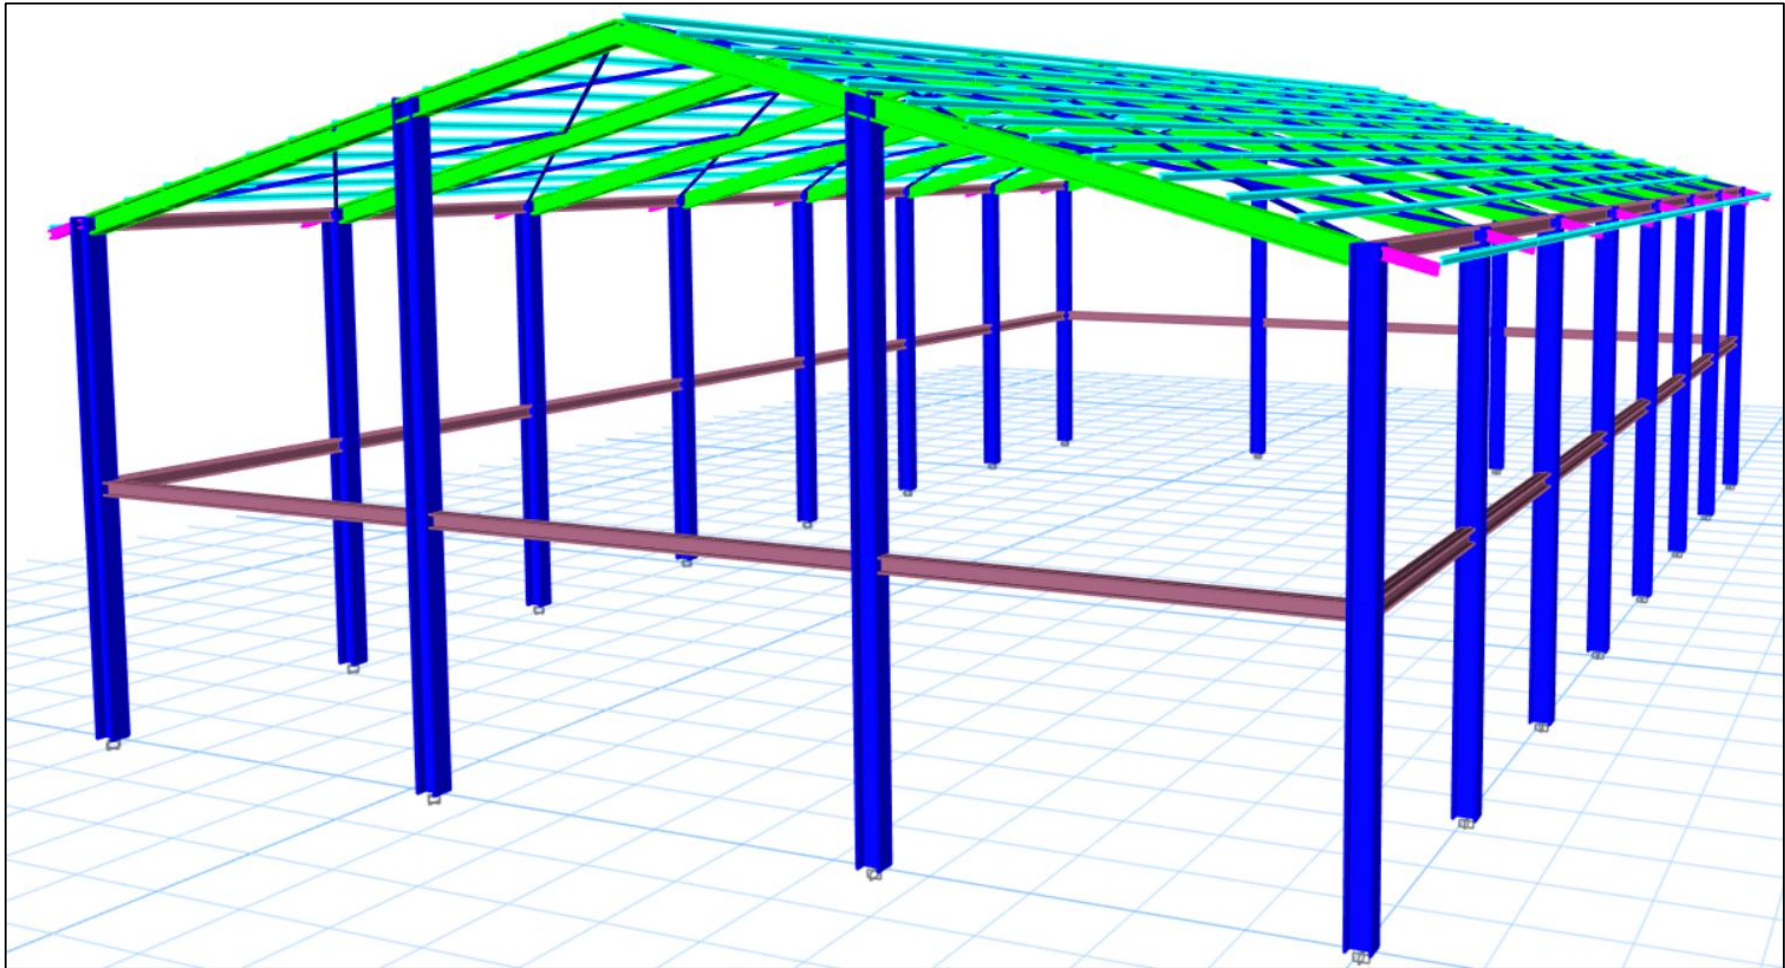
Tampak Depan Struktur Gedung Serbaguna Balok Rafter Profil WF
